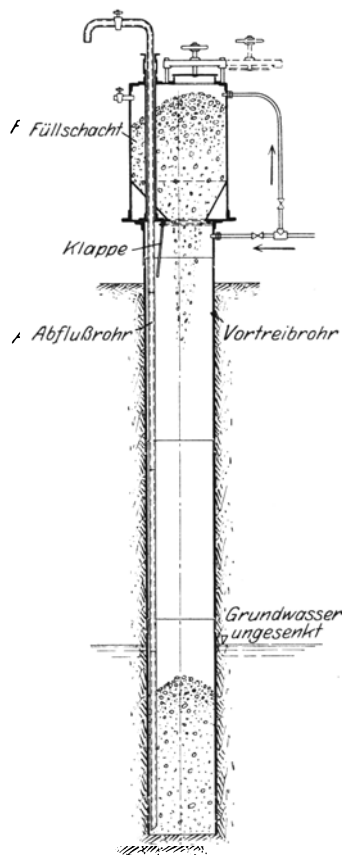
Schleuse und Einrichtung zur Betonierung des Preßbetonpfahles von Grün & Bilfinger.
